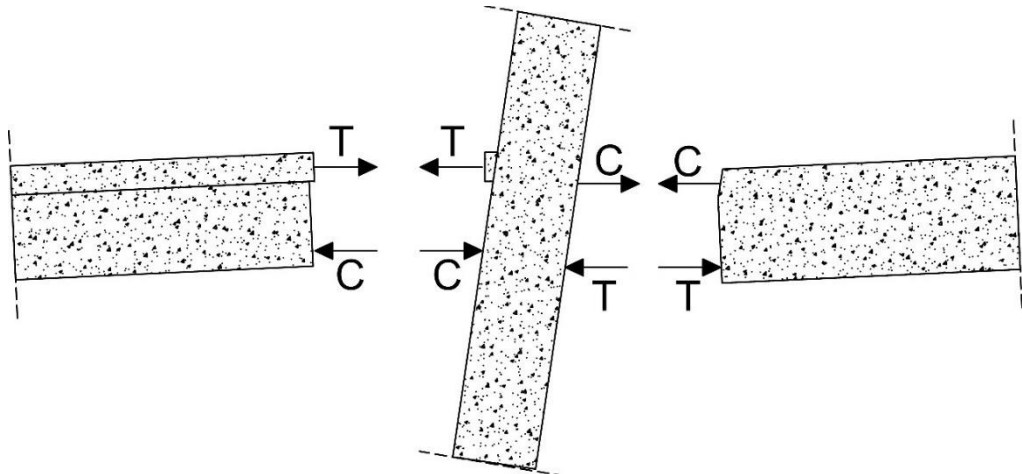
Esquema de forças gerado na ligação viga/pilar.
